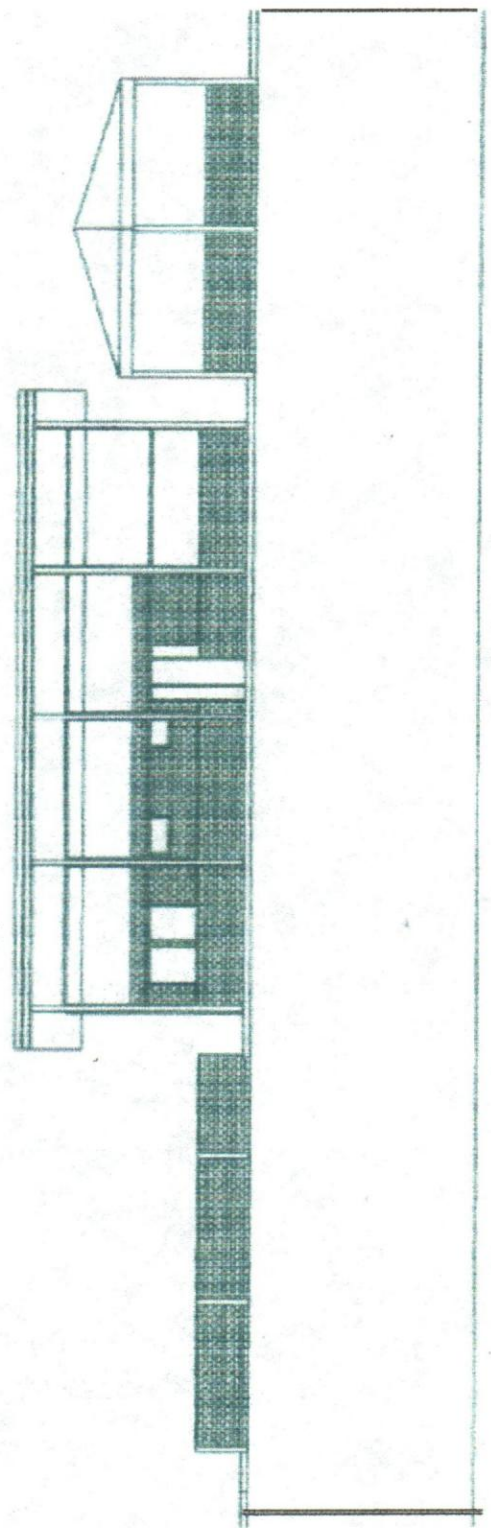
Vivero U.C.A.B.; plano de estructura – fachada principal.
